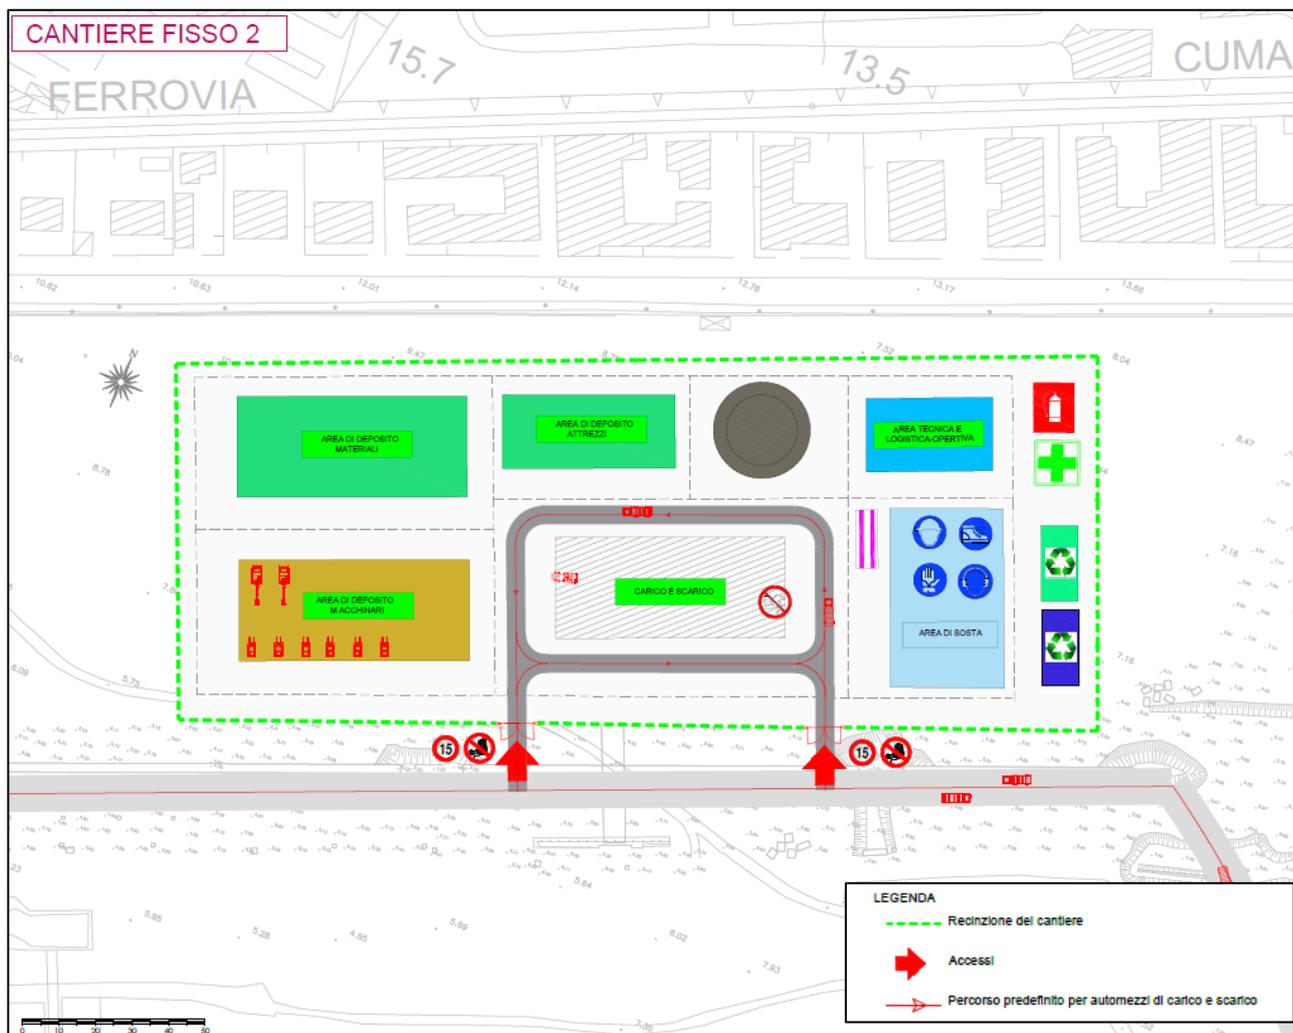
Planimetria Cantiere Fisso 2 (Elaborato: 2021INV-D-PS-PL.10.01.02.01)
